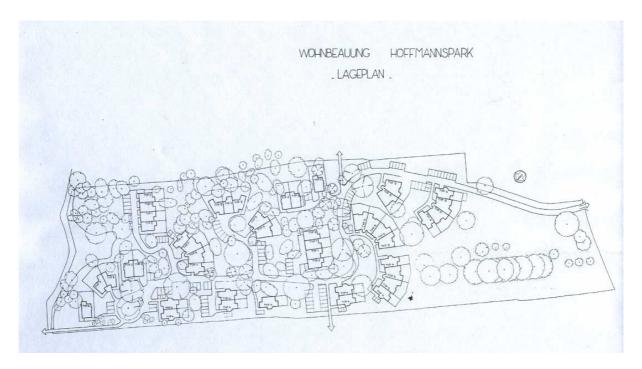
Lageplan Hoffmannspark (Quelle: www.architekturfuehrer-bremen.de)
